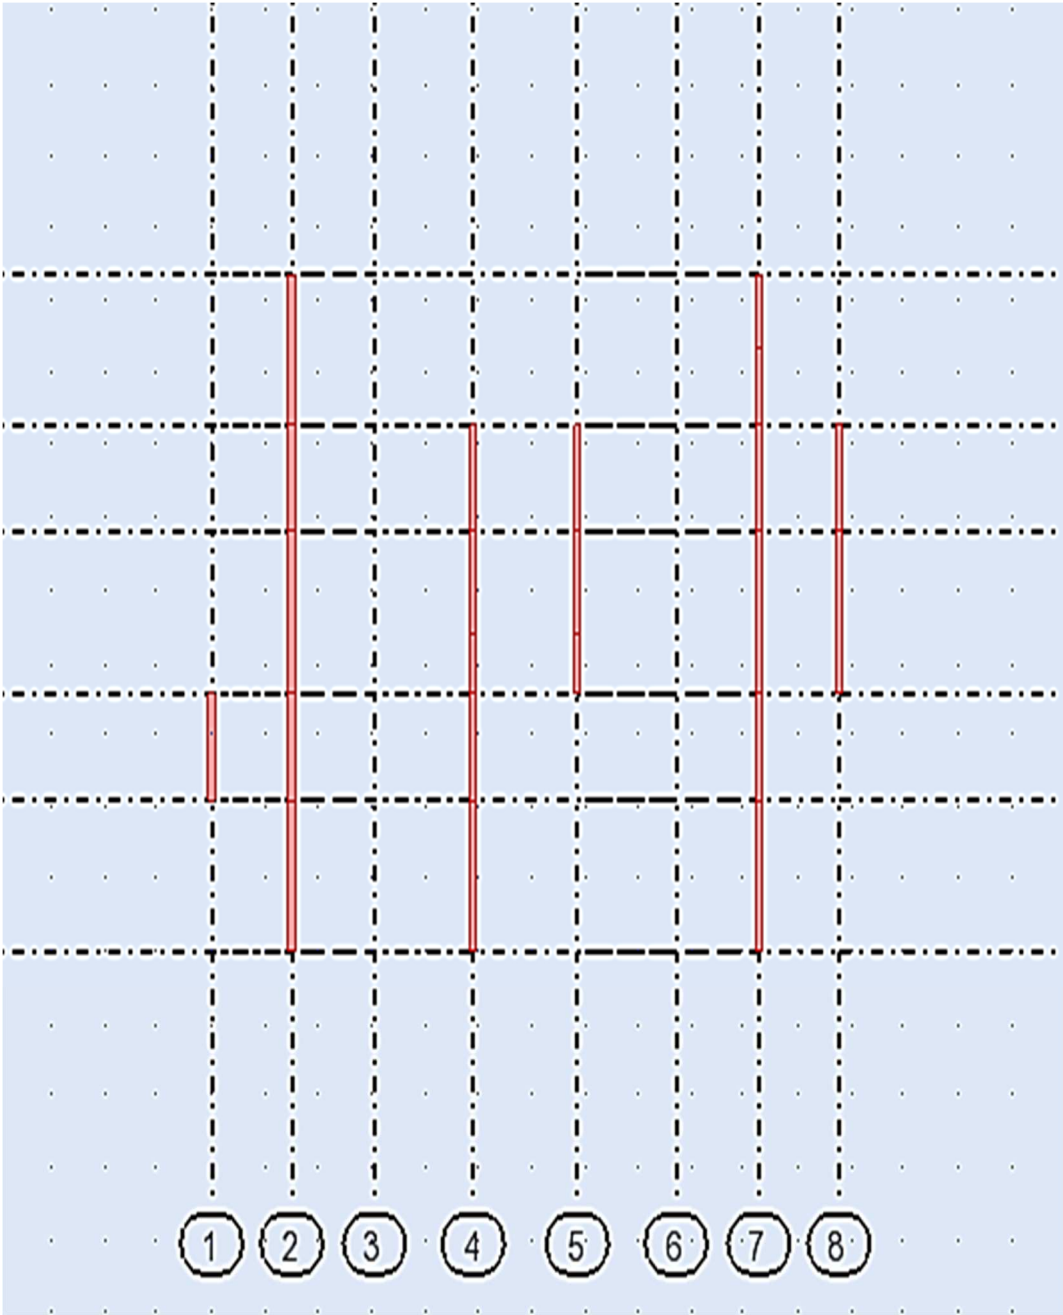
Représentation en plan des poutres principales adhérees aux voiles au niveau de la structure.
